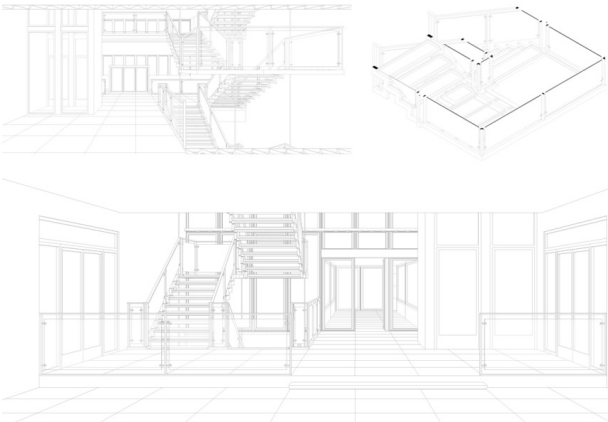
Detalle constructivo en axonométrico y vistas frontales, de la escalera, contrapuestas de la entrada y salida del edificio.
